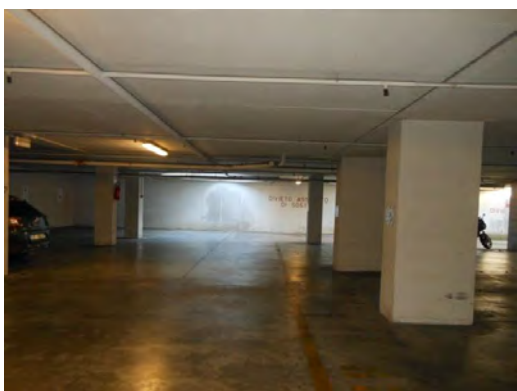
Pianta rilievo fotografico del primo piano interrato
